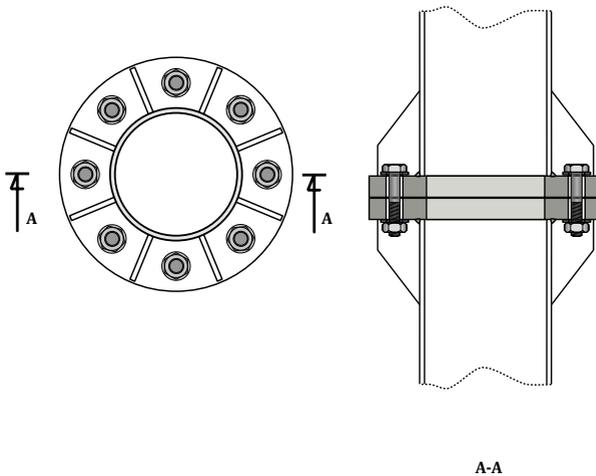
Assemblage de continuité par brides – Poteaux à section creuse circulaire
